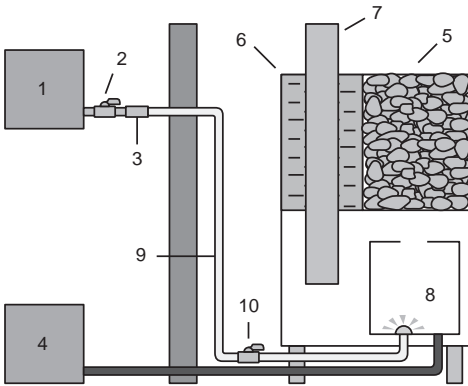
Печь-каменка на жидком топливе: 1 — резервуар для топлива; 2 — вентиль; 3 — фильтр; 4 — бак-накопитель; 5 — отсек для камней; 6 — бак для воды; 7 — дымоход; 8 — камера сгорания; 9 — топливный провод; 10 — вентиль для регулирования подачи топлива
